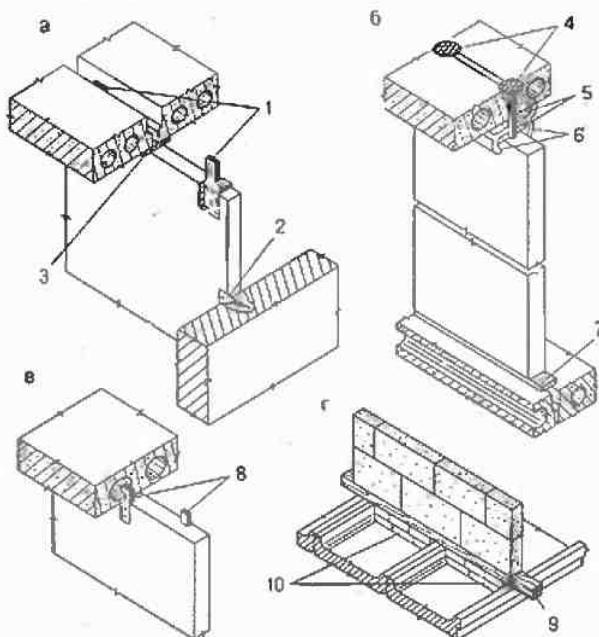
Крепление перегородок и их заделка в местах примыкания
